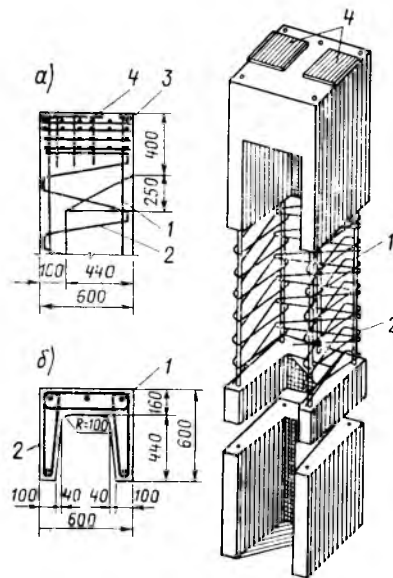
Схема колонны высотой 9,6 м а — конструкция оголовка; б — поперечное сечение; 1 — продольная преднапряженная арматура; 2 — поперечная арматура в виде спирали; 3 — арматурные сетки; 4 — закладное изделие
